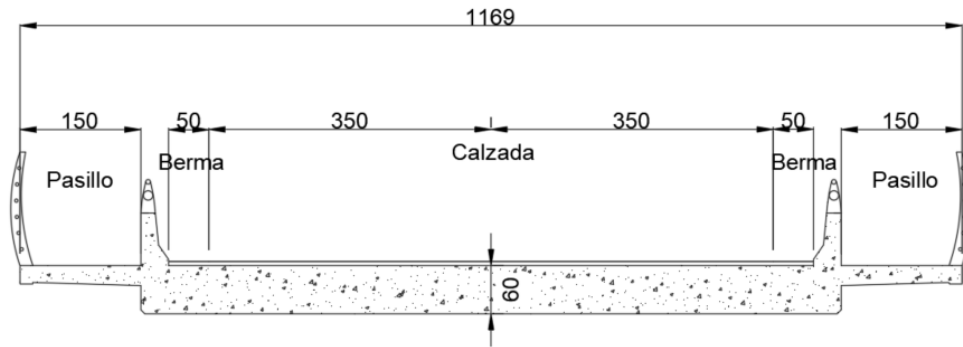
Tablero Puente 486-ES Laraquete (dimensiones en cm).
